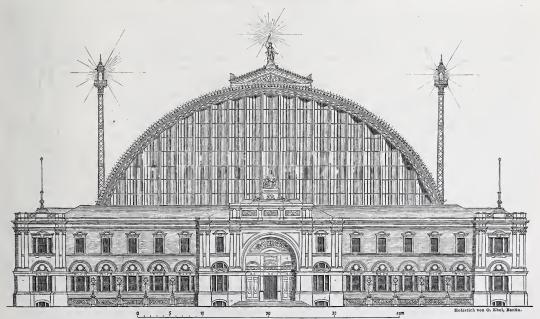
Ansicht des Kopfbaues mit dem Hallenabschlufs.
